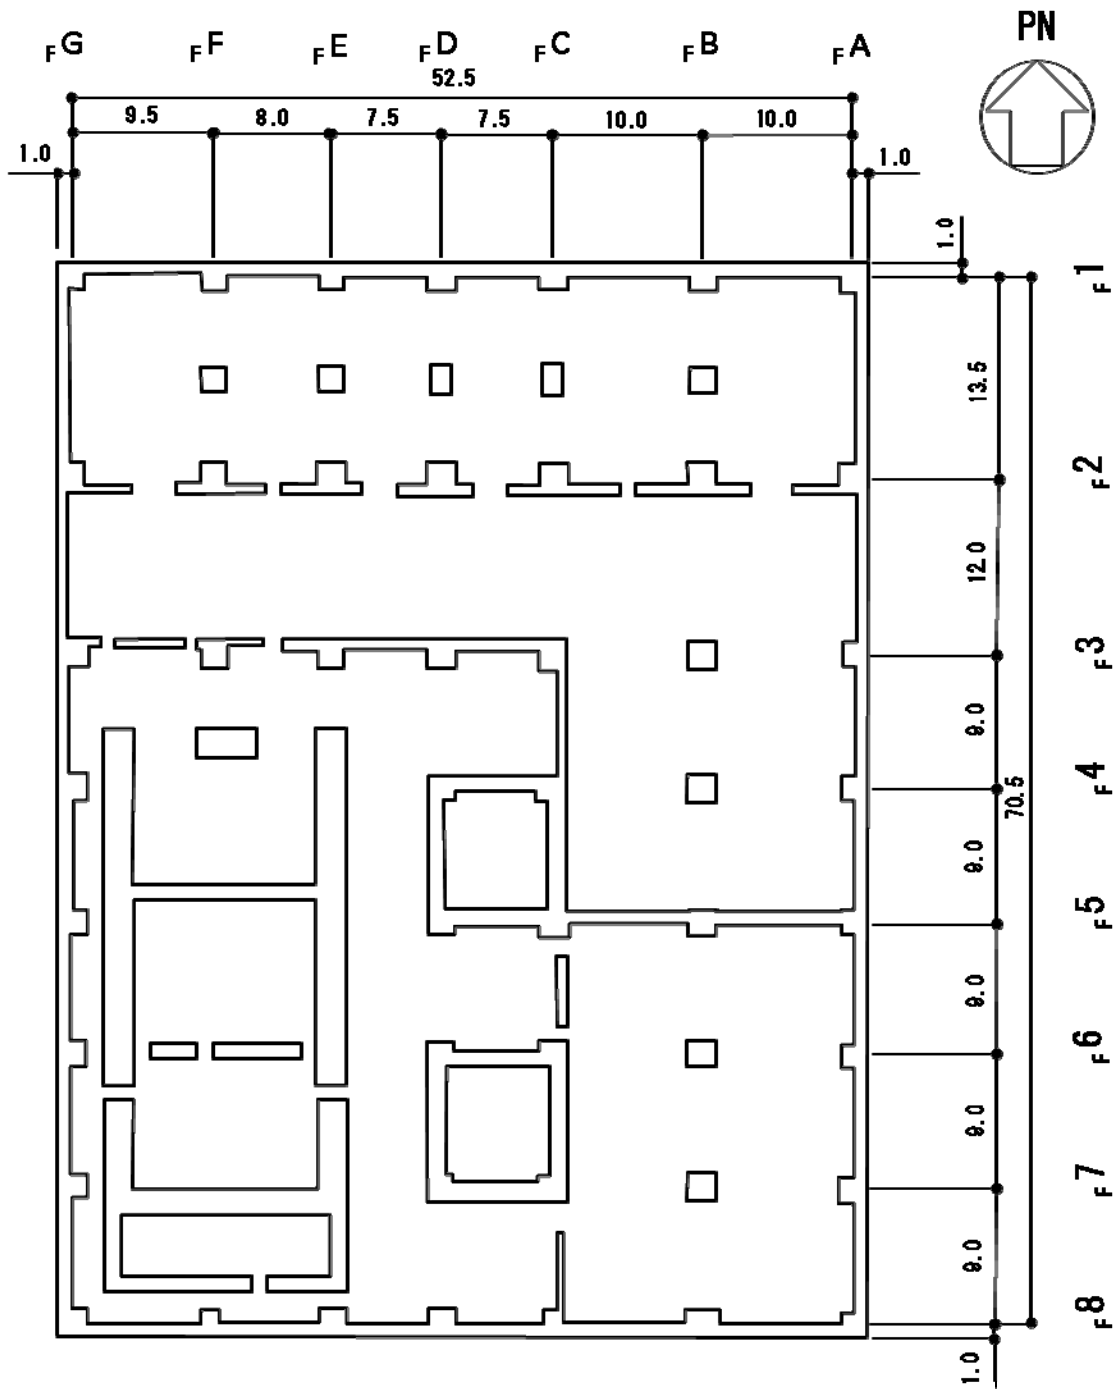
PL/B 基礎版レベル平面図(O.P. 2.7m) (単位 : m)
